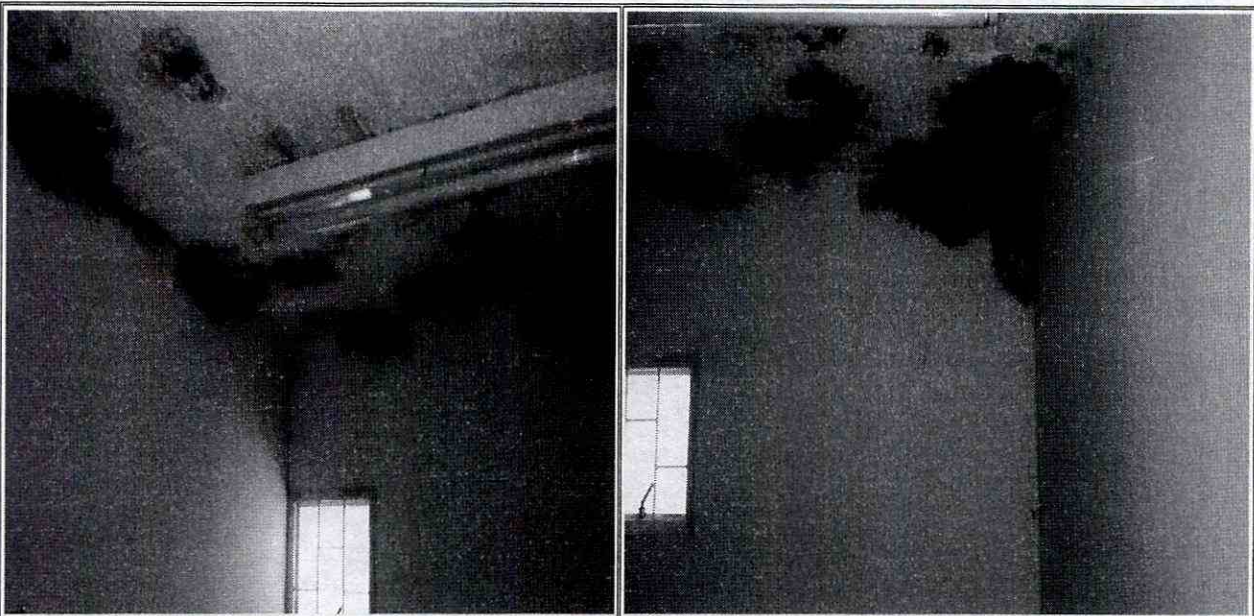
y 3. Humedades en losa en concreto que sirve como estructura de cubierta del Salón Comunal de la Vereda Peñalisa
